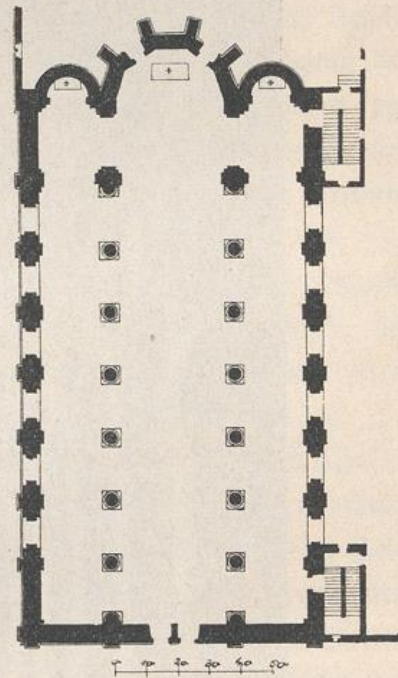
Brüssel. Jesuitenkirche. Grundriß. Erster Plan.
